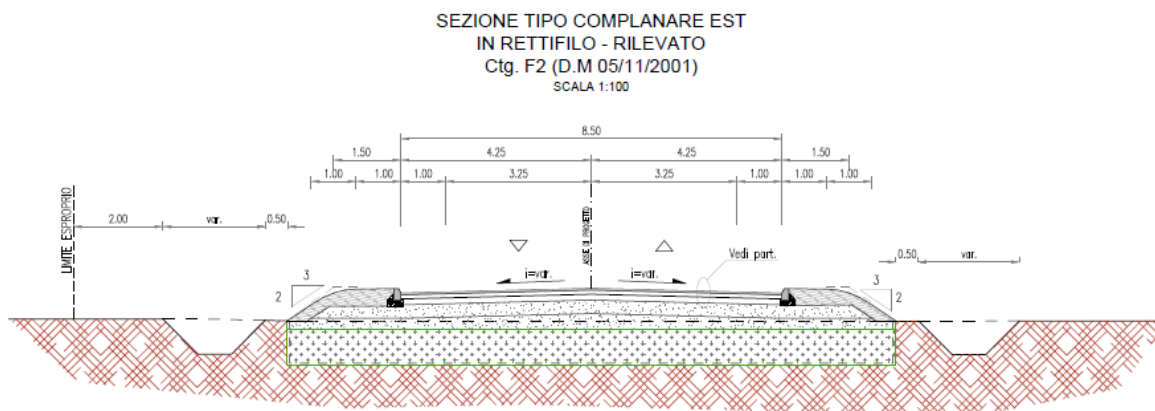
Sezione Tipo Complanare Est in rettilo
